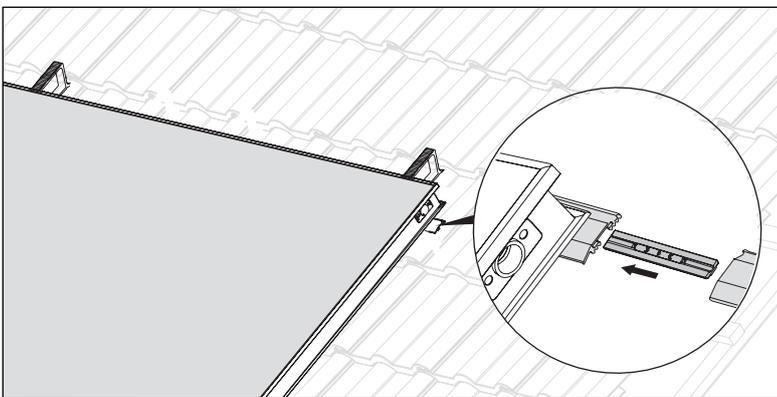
Collegamento delle guide di montaggio (disposizione adiacente del campo)
